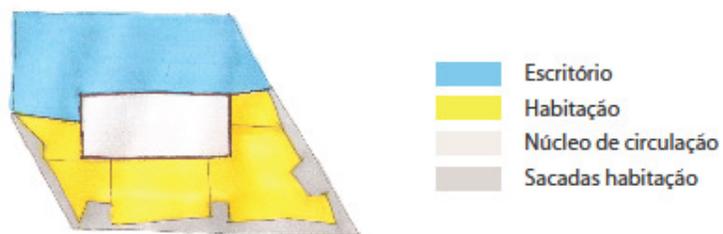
Esquema da distribuição dos programas em planta no 13º pavimento.
